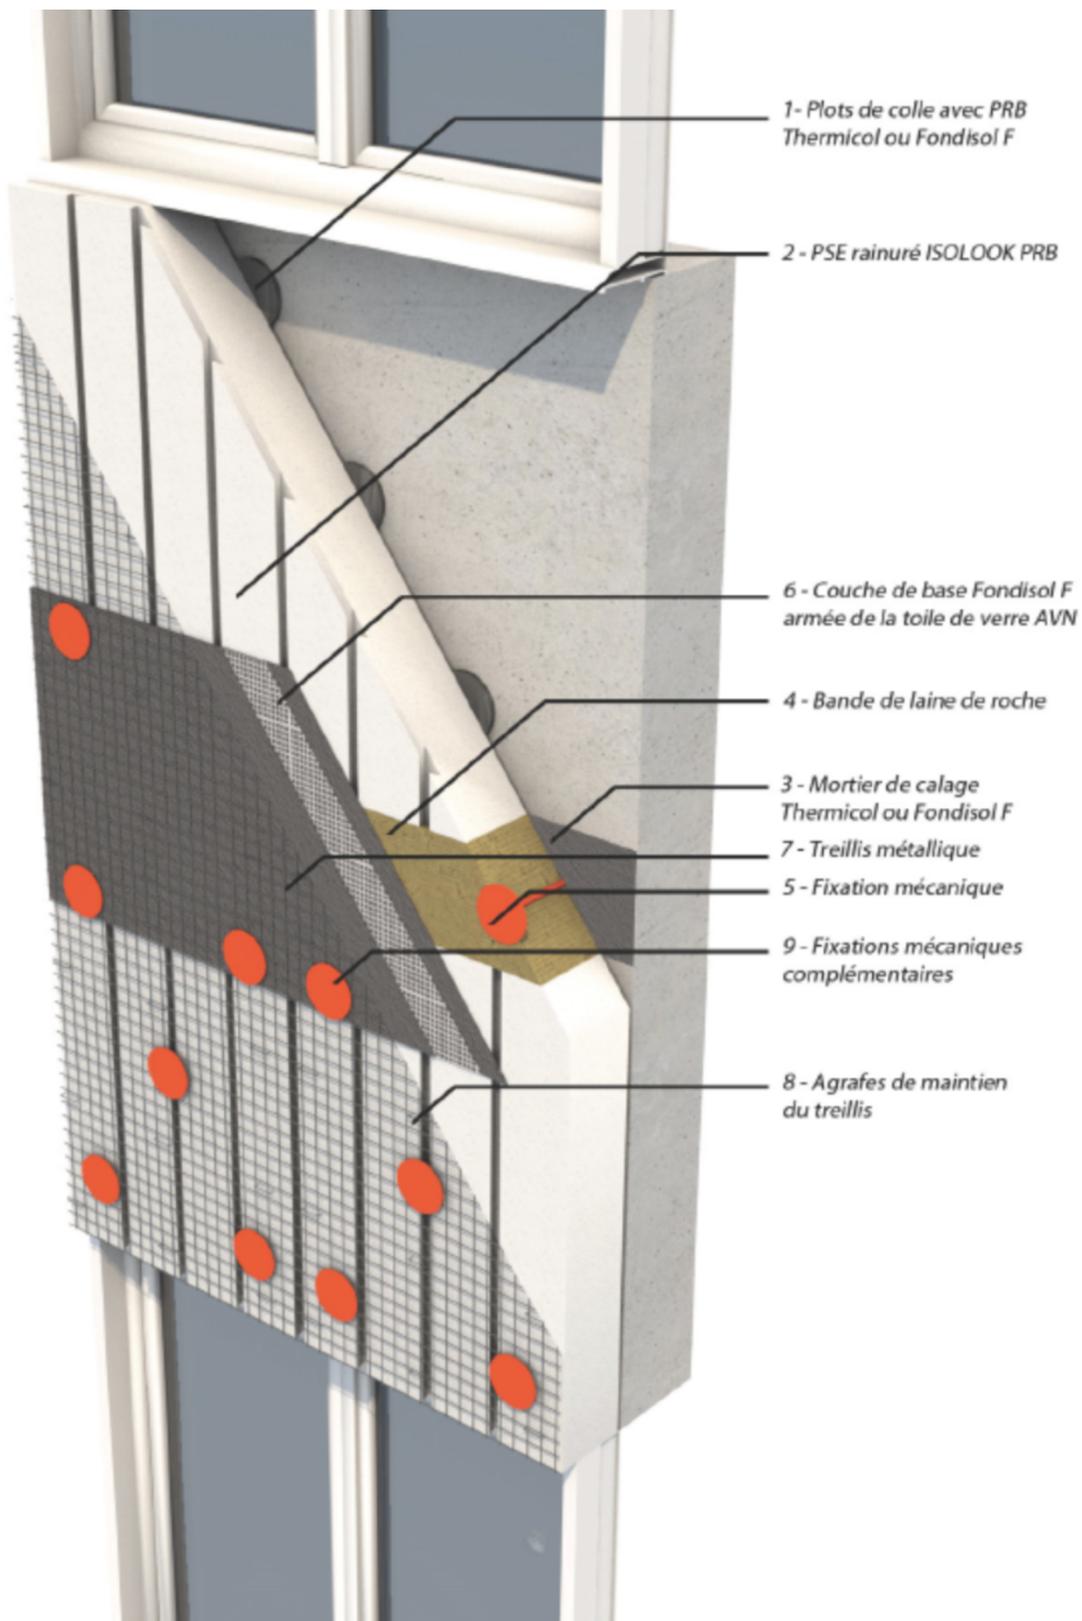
Vue en coupe du système complet au droit d'une bande filante
